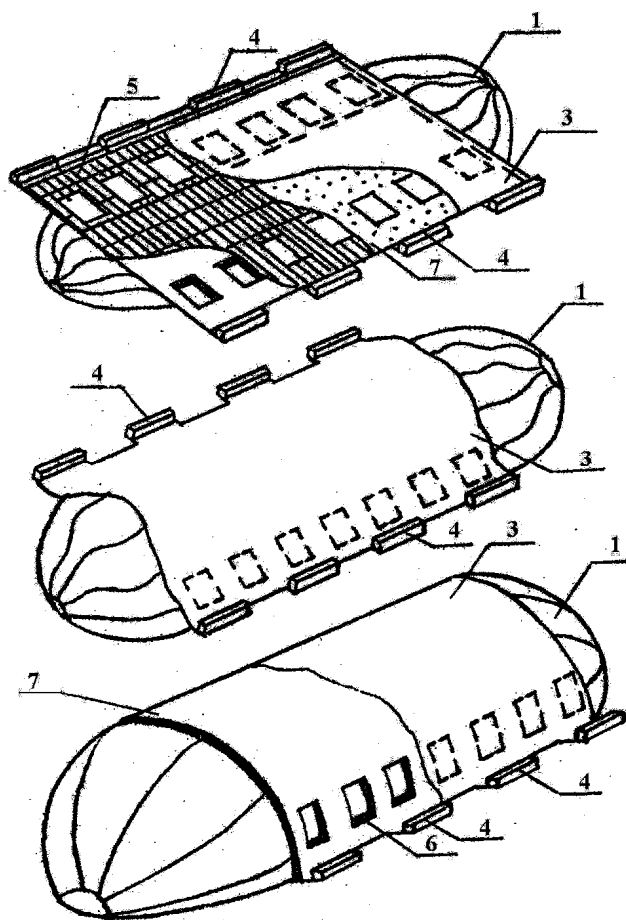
Схема изготовления гладкого цилиндрического свода способом погиба: 1 - пневмоопалубка, 2, 3 - формирующее и удерживающее полотнища пневмоопалубки, 4 - пригрузы, 5 - арматурный каркас, 6 - оконные проемы, 7 - бетонная смесь
